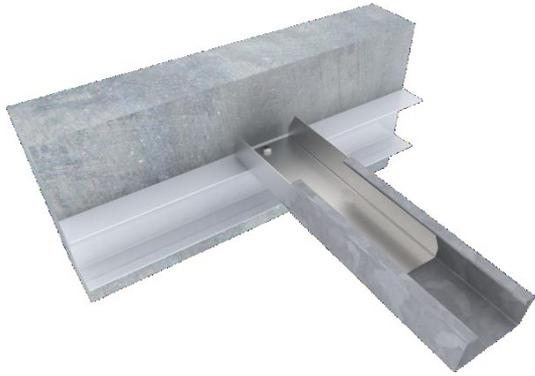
Fissaggio dell'accessorio su profilo perimetrale con vite - VINCOLO CONDIZIONATO
